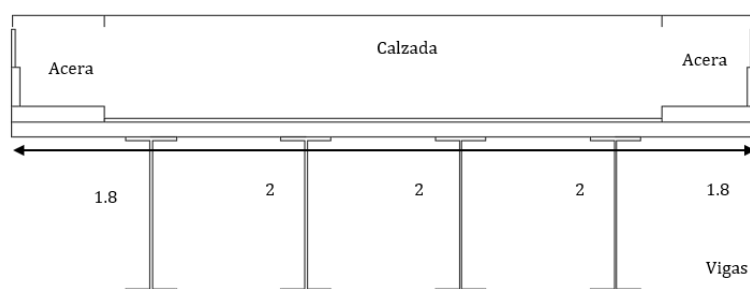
Superestructura de viga de acero y losa de hormigón armado
